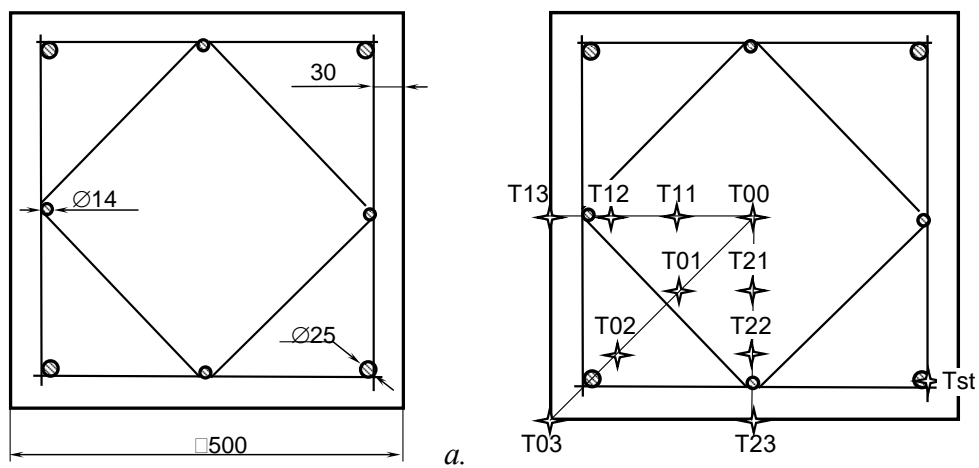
Схема армирования (а) и схема расположения термодатчиков (б) железобетонной колонны
